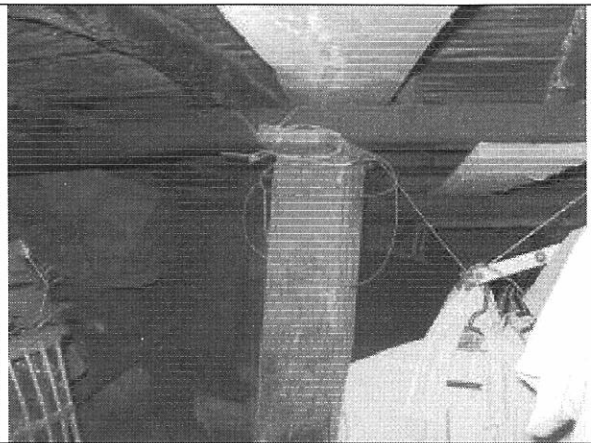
Apoyo inestable en la parte inferior de la construcción de la zona frontal
